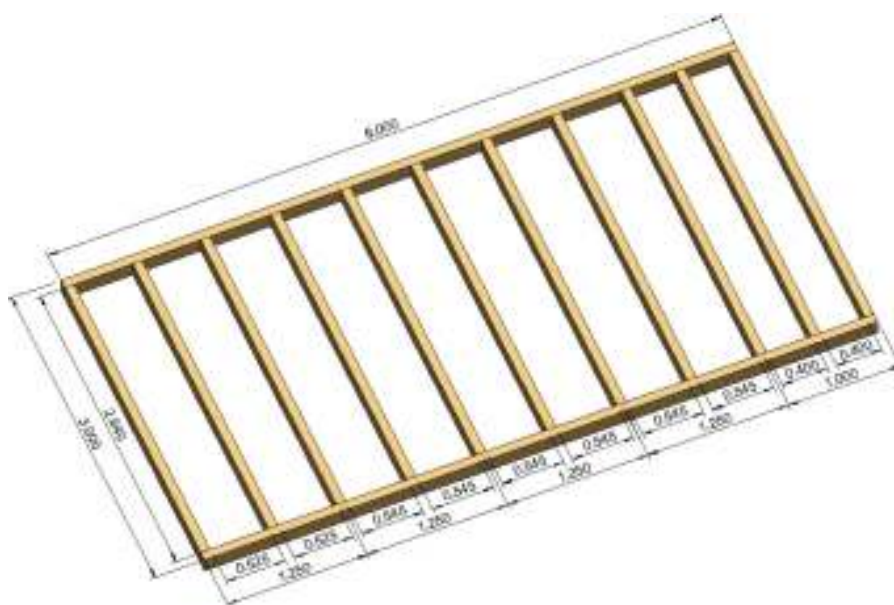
Laje de pavimento constituída por vigas lameladas coladas.
